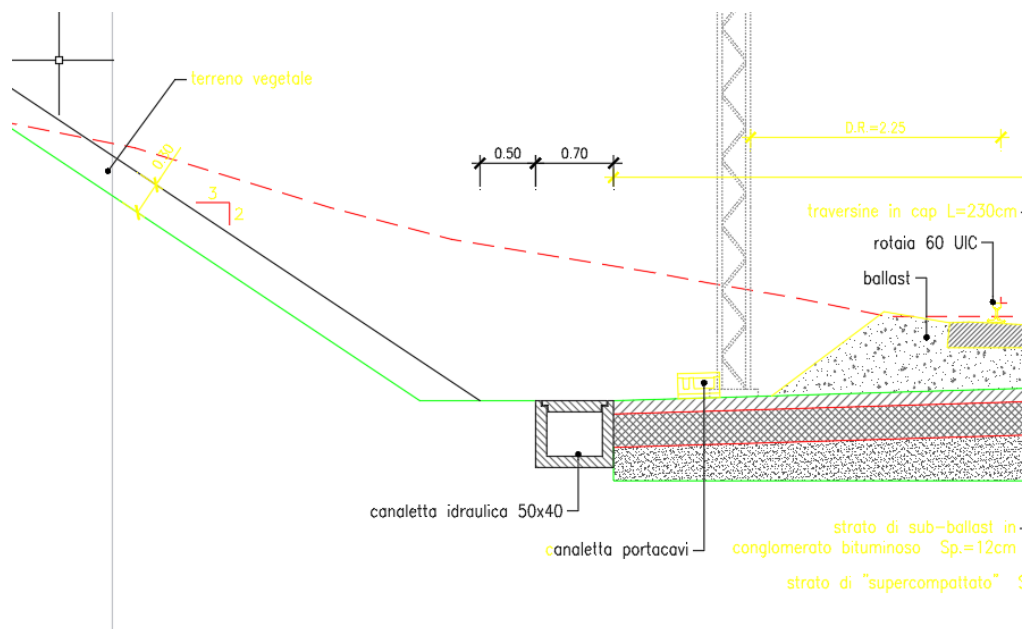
posizione della canaletta rettangolare al piede della trincea
